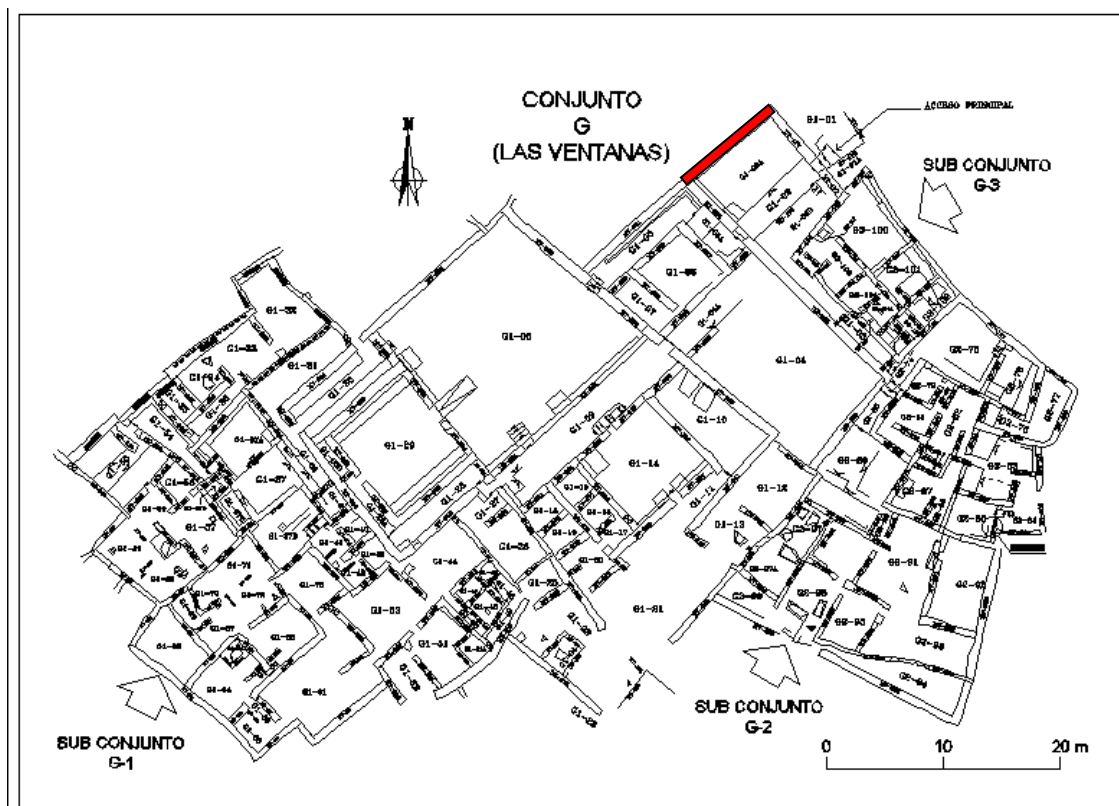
Plano de ubicación del muro MG-178 conjunto G – sub sector
